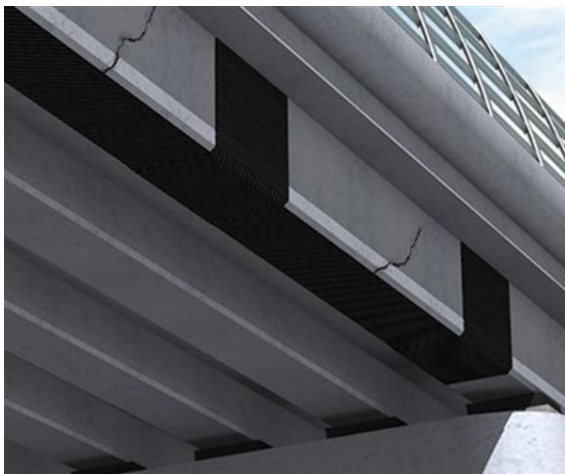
Reforzamiento a flexión en viga de concreto (Masterbuilders, s.f).
